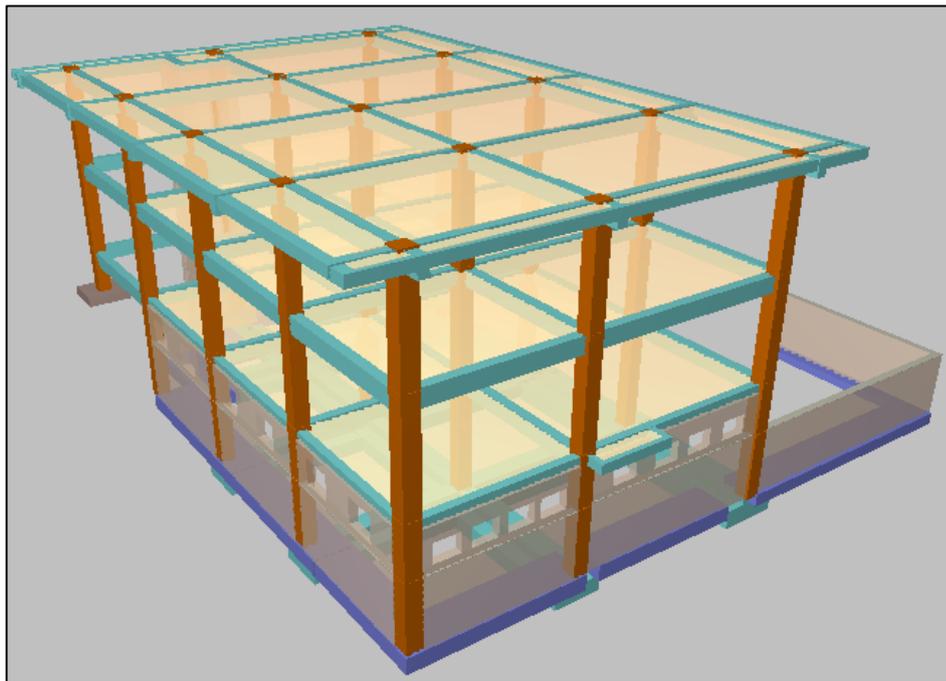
Modelo de la estructura en hormigón armado (lado derecho)
